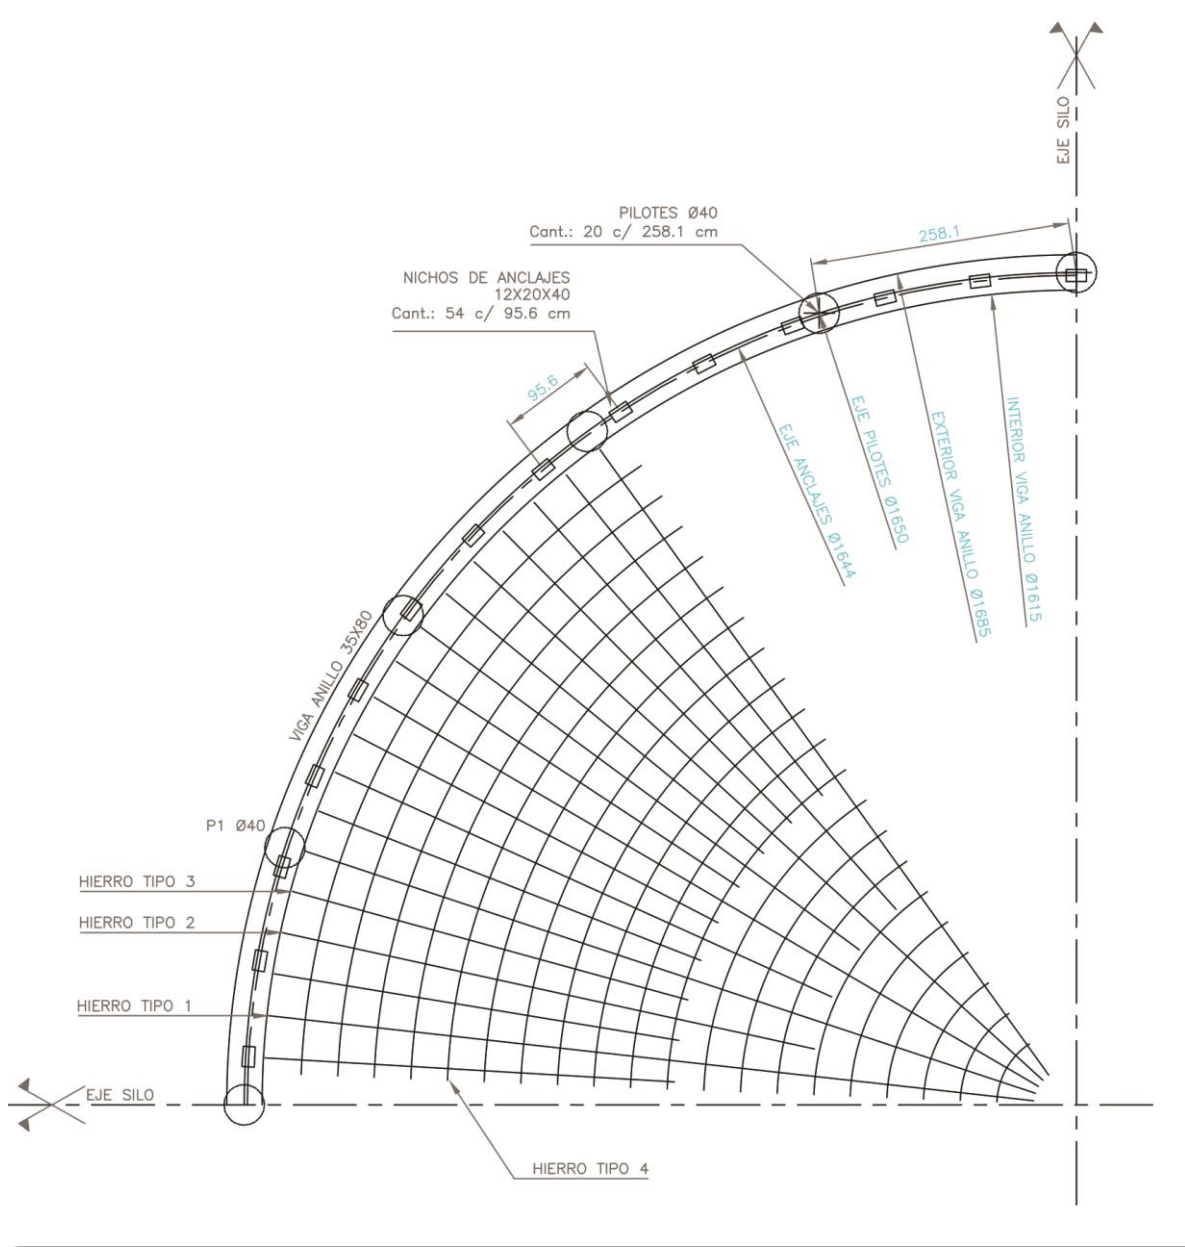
Alternativa de Fundación Arinco - Vista en planta de fundaciones y armado de losa de fondo
